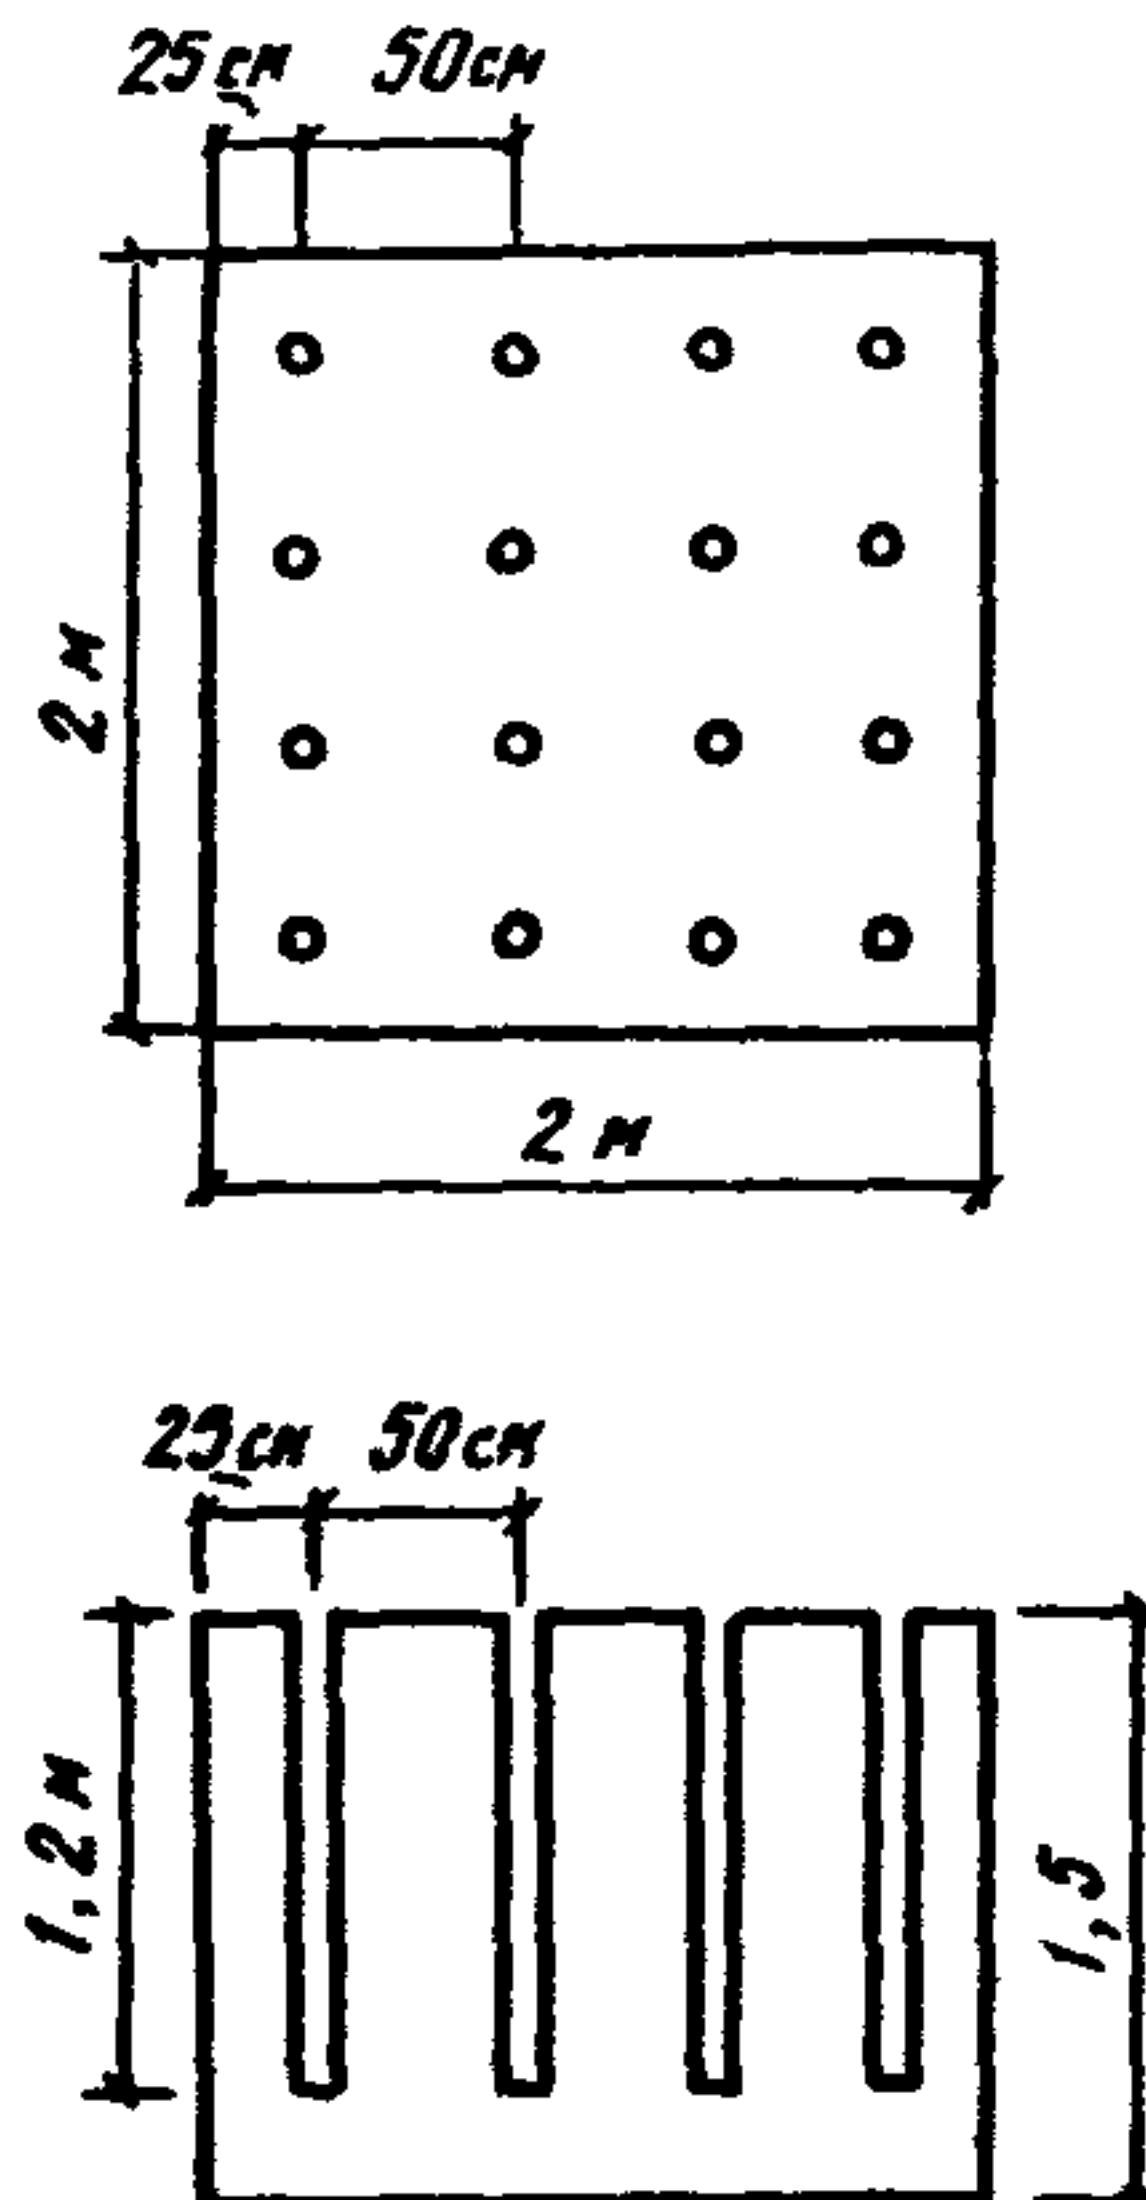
План расположения шпуров при разрушении бетонного фундамента
